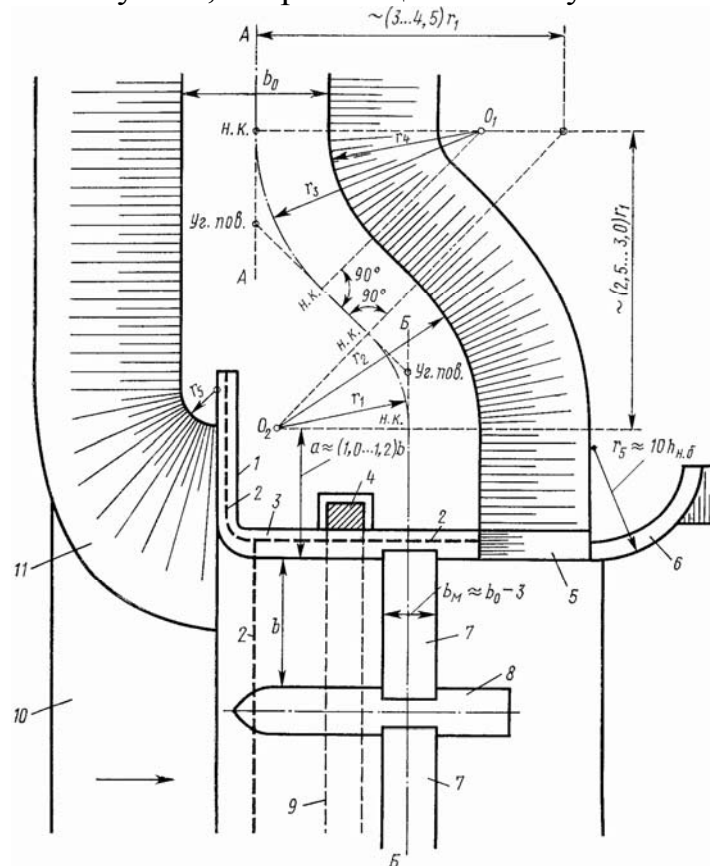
Устой, сопрягающий бетонную плотину с земляной (схема): $A-A$ - ось земляной плотины; $B-B$ - ось транзитного моста плотины; 1 - обратная стенка; 2 - шпунтовый ряд; 3 - продольная стенка устоя с горизонтальным гребнем; 4 - шахта (вход в потерну); 5 - откосный открьлок; 6 - откосный открьлок с горизонтальным гребнем; 7 - транзитный мост; 8 - бык; 9 - потерна; 10 - понур; 11 - конус земляной плотины, «вдвинутый» в пролет; b_o - ширина гребня земляной плотины; b_m - ширина моста; b - ширина отверстия плотины; $Уг. пов.$ - угол поворота; $НК$ - начало кривой оси плотины; r - радиусы; $h_{НБ}$ - глубина НБ
